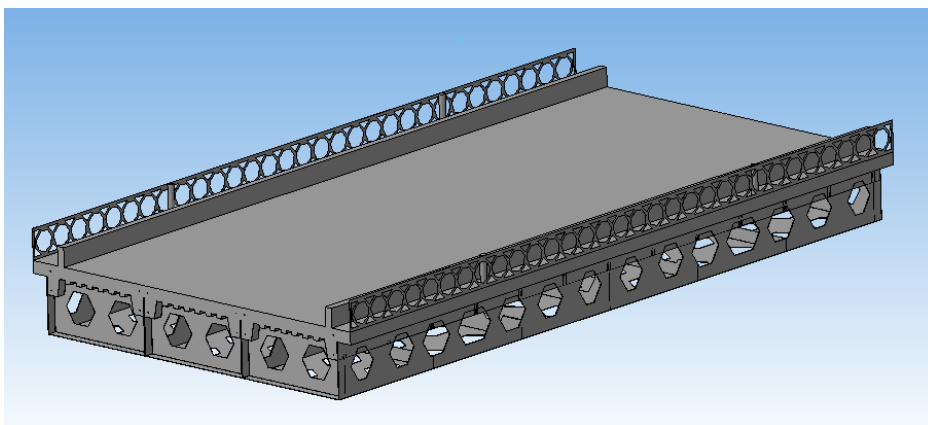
Фрагмент розглянутої сталезалізобетонної прогонової будови мосту.
